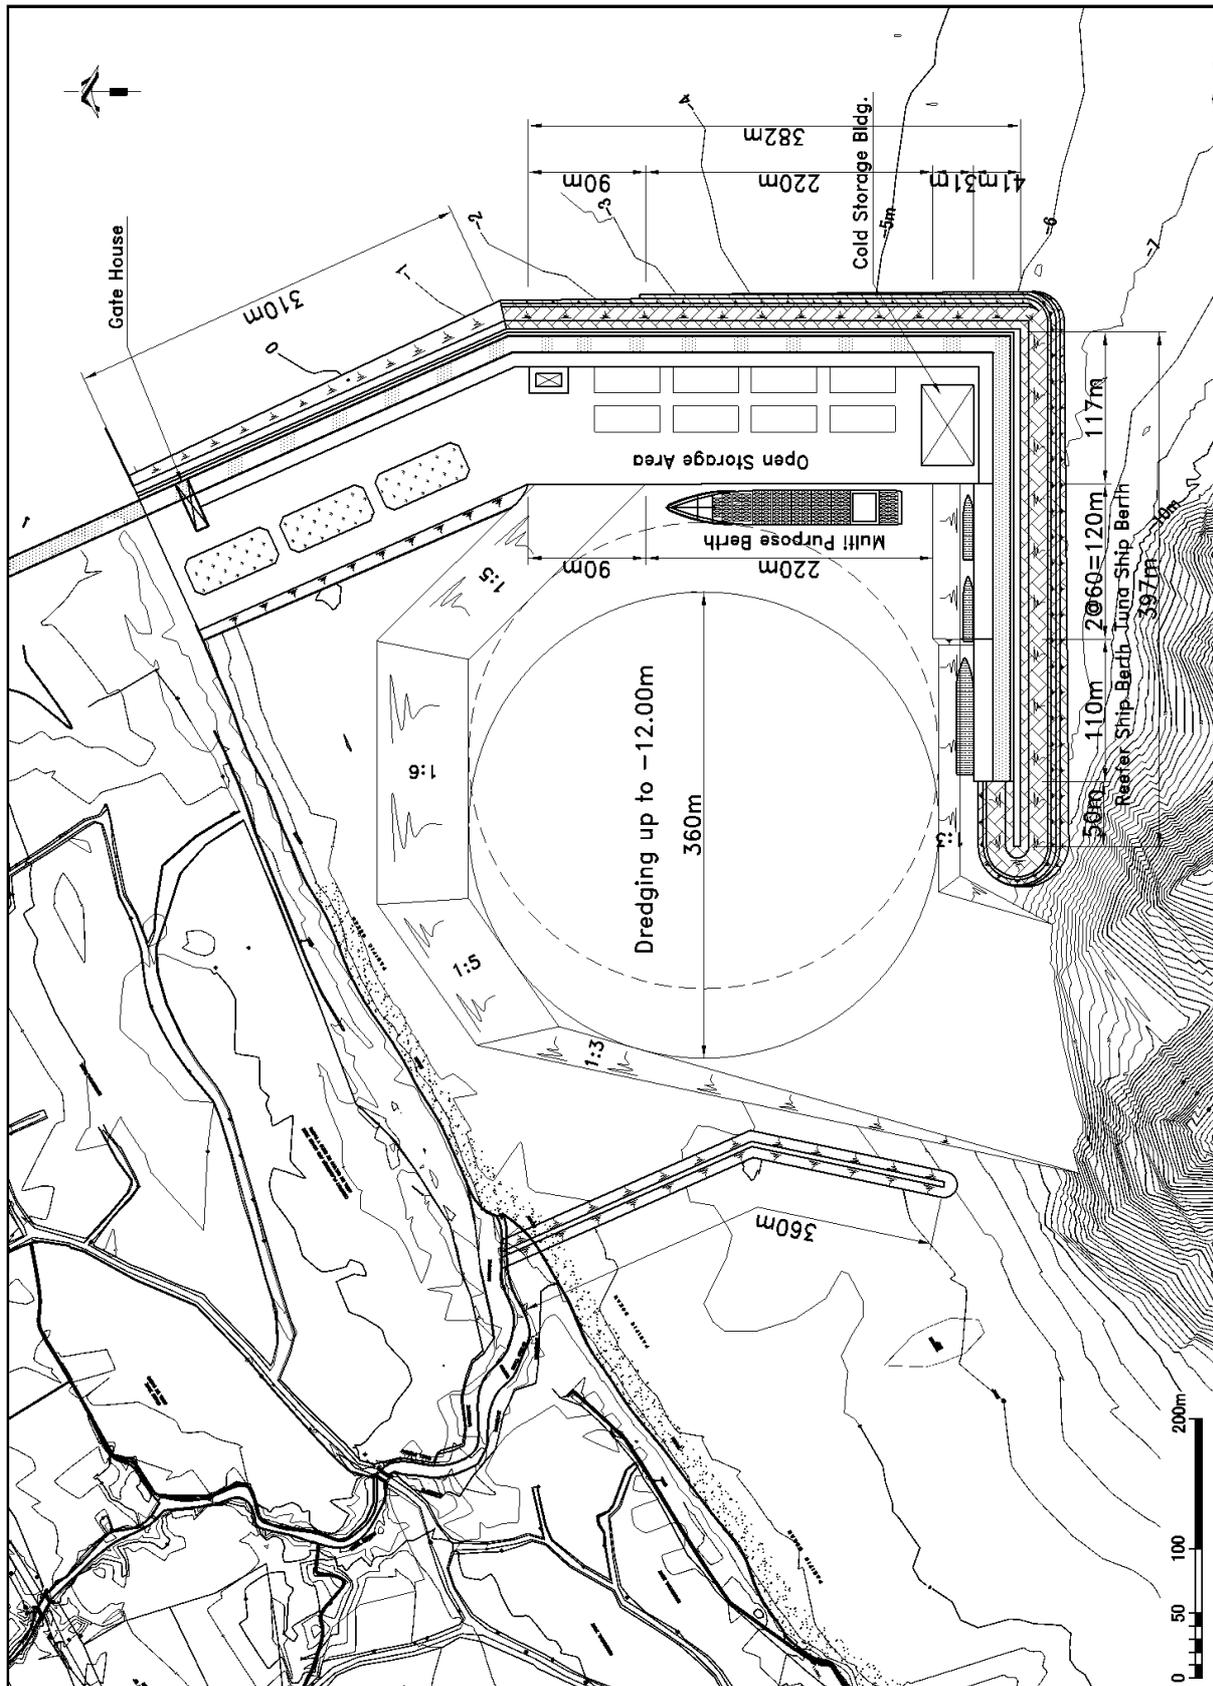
Disposición General Plan Instalaciones Marinas
